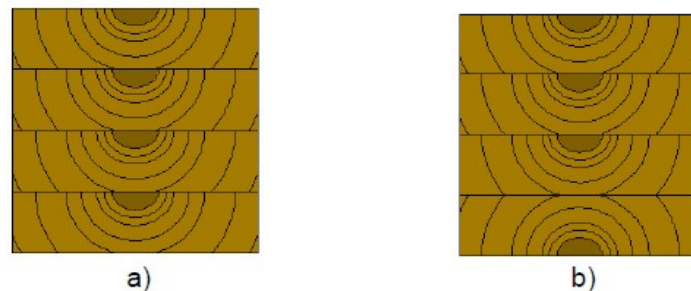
Orientação das lamelas na secção transversal (NP EN 386, 2009)
